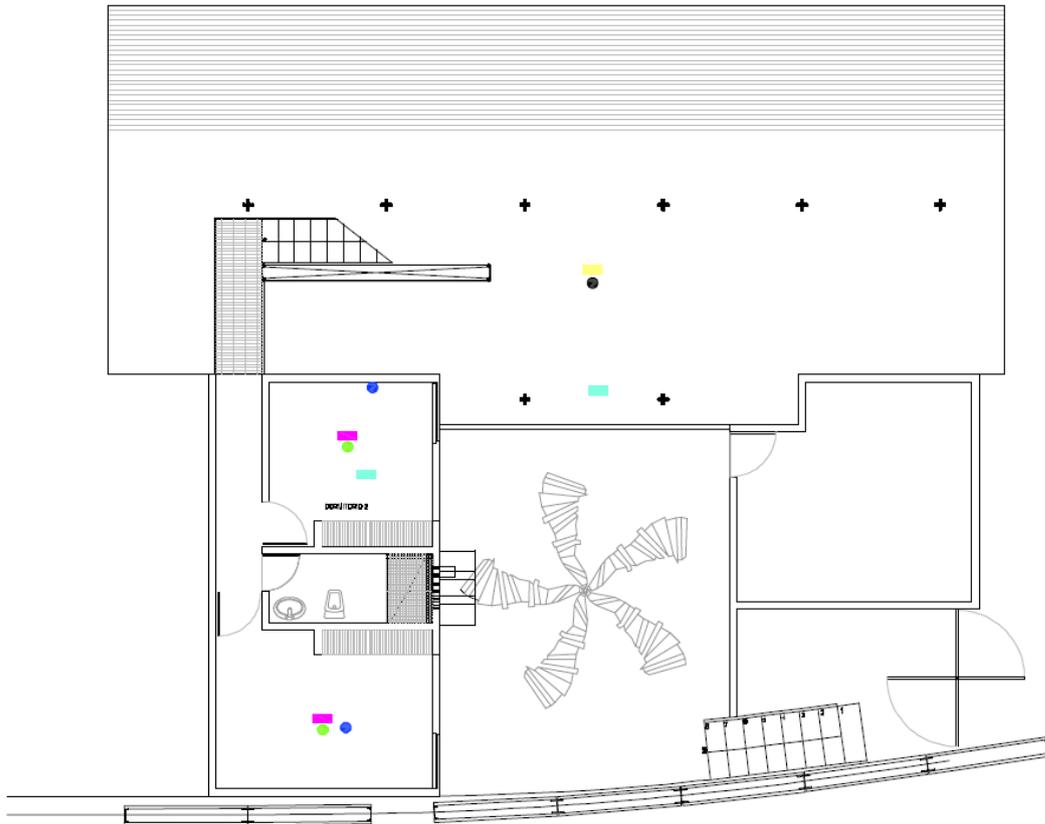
Localización de los sensores en planta baja de la vivienda 21 La Religa
